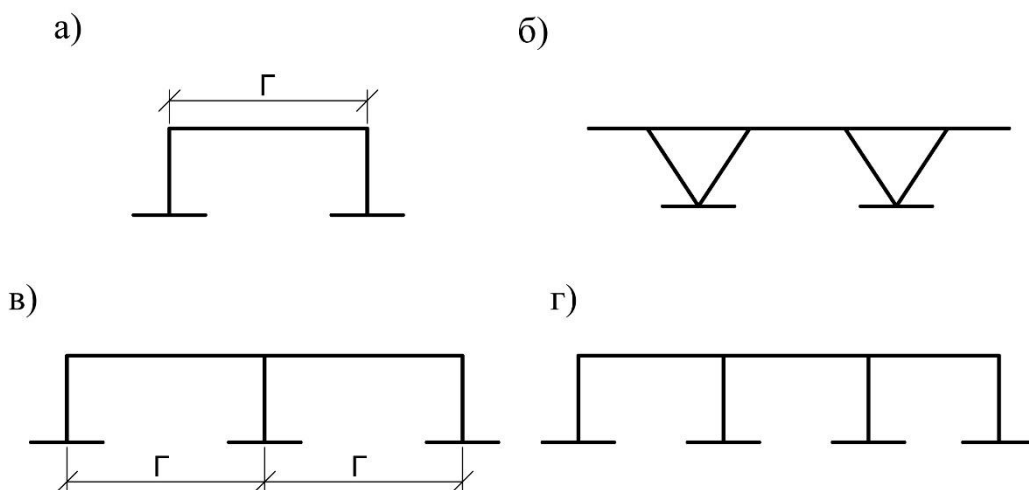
Схемы рамных путепроводов: а – однопролетная; б – с наклонными стойками; в – двухпролетная; г - трехпролетная
